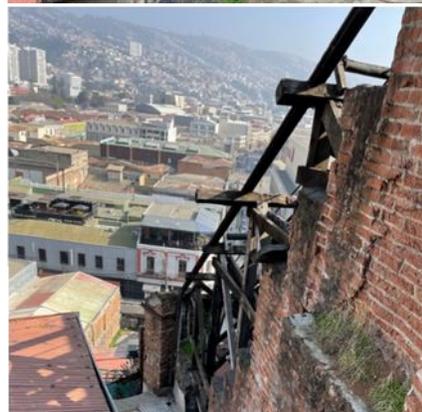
, muros de albañilería sobre los que se posa la estructura de madera y acero, MJL 2021
